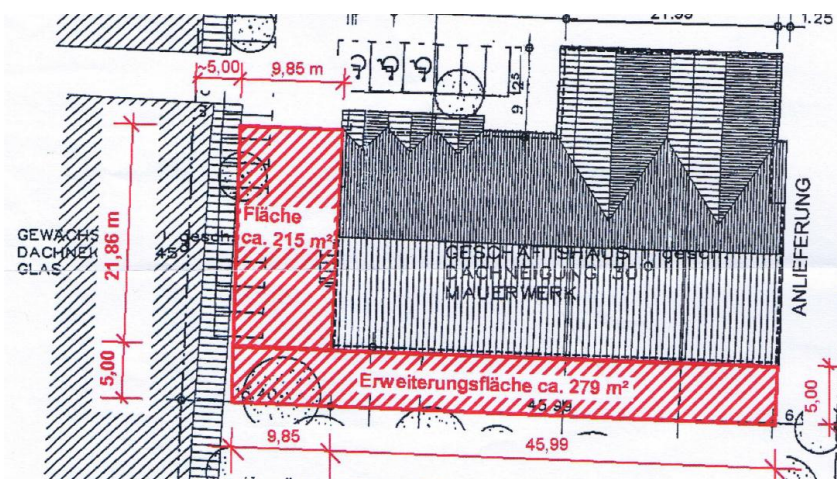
Darstellung der geplanten Eingriffsflächen
